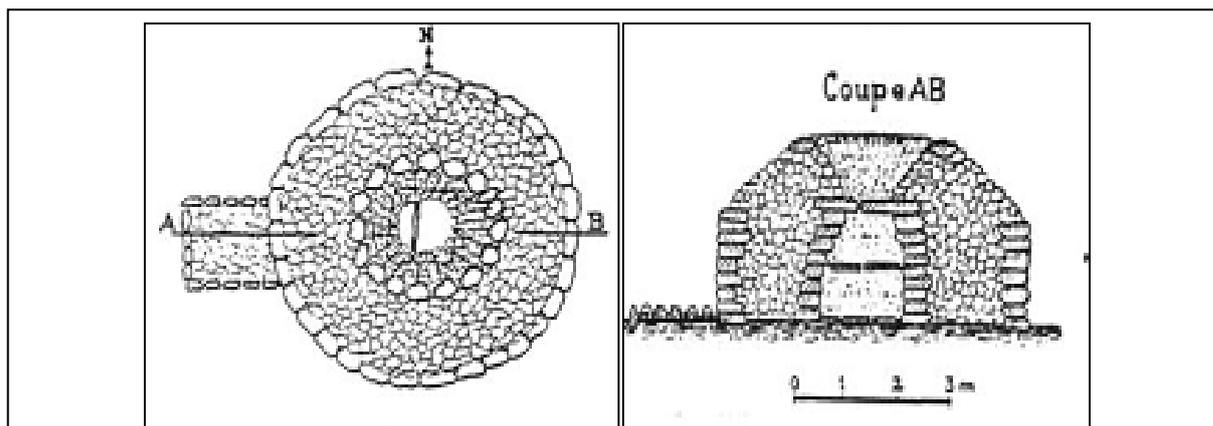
Plan et coupe de bazina à carapace.
